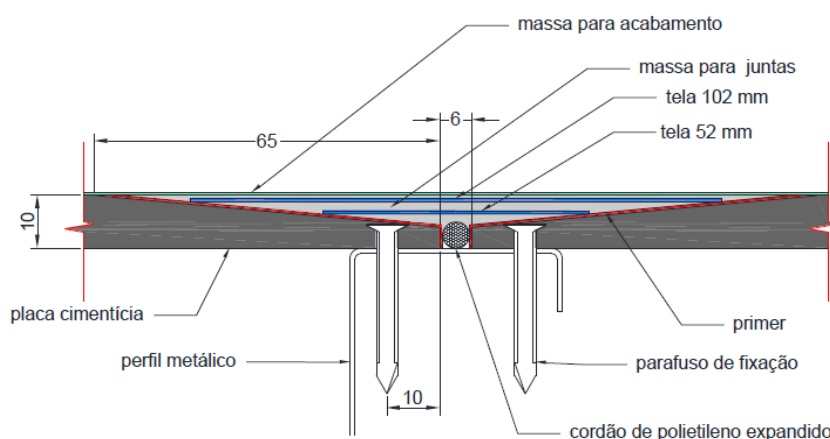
Corte esquemático do Tratamento de juntas entre placas cimentícias
